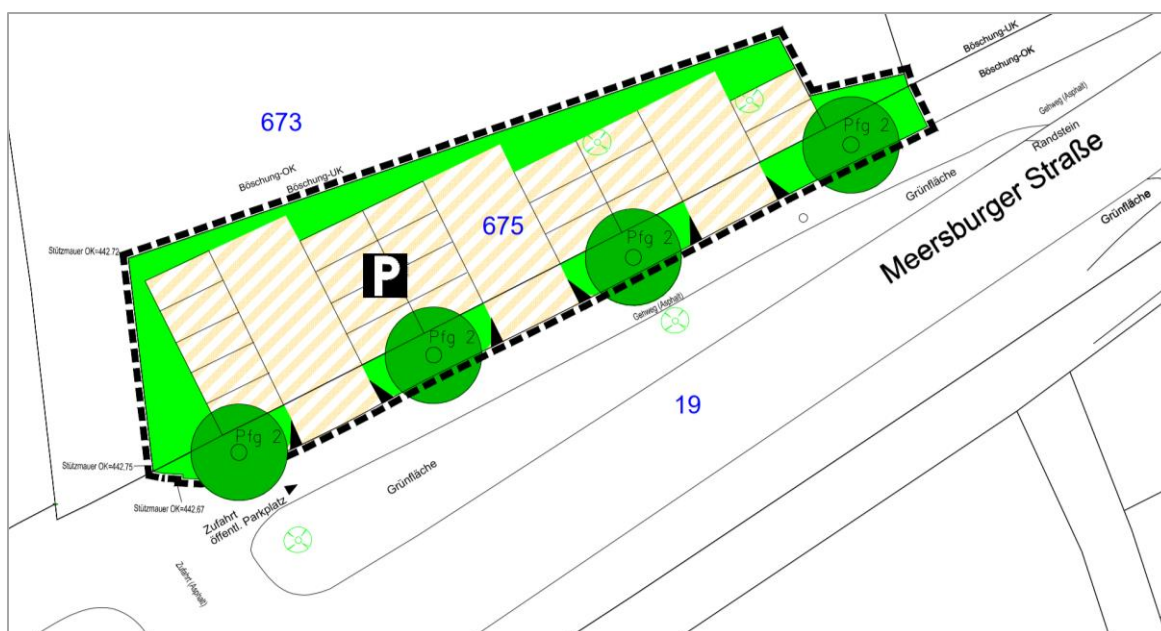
Ausschnitt öffentlicher Parkplatz, Planstatt Senner, Stand Januar 2024
